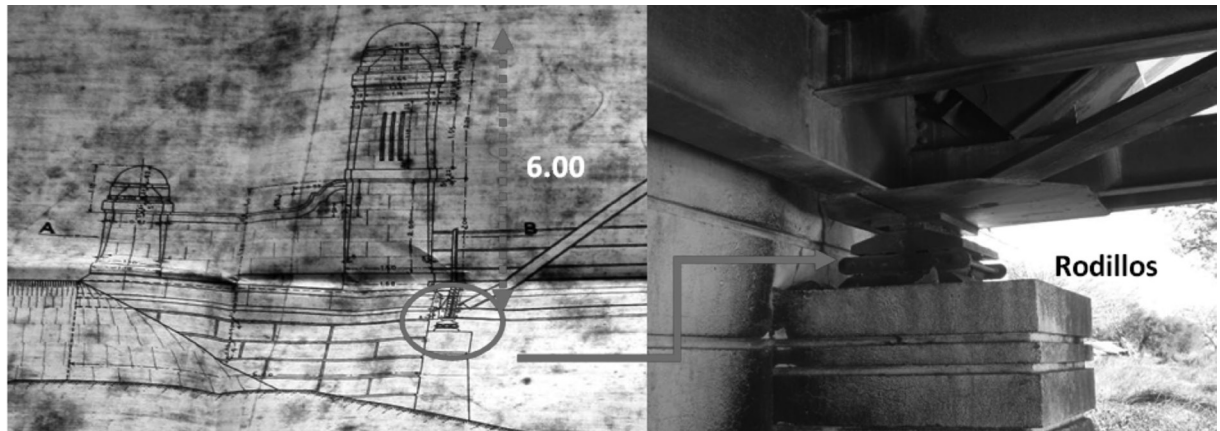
Plano de obra. Sección transversal del muro y comienzo de la superestructura. Fuente: Dirección de Hidráulica Sección Dolores.
